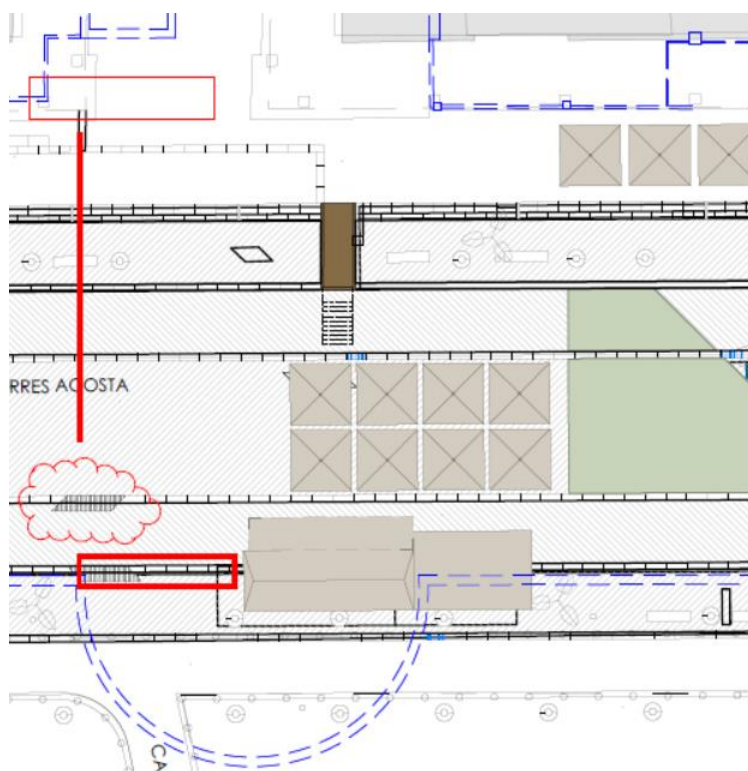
Hueco en superficie adyacente al pilar del eje 7 y juntas de cubierta
